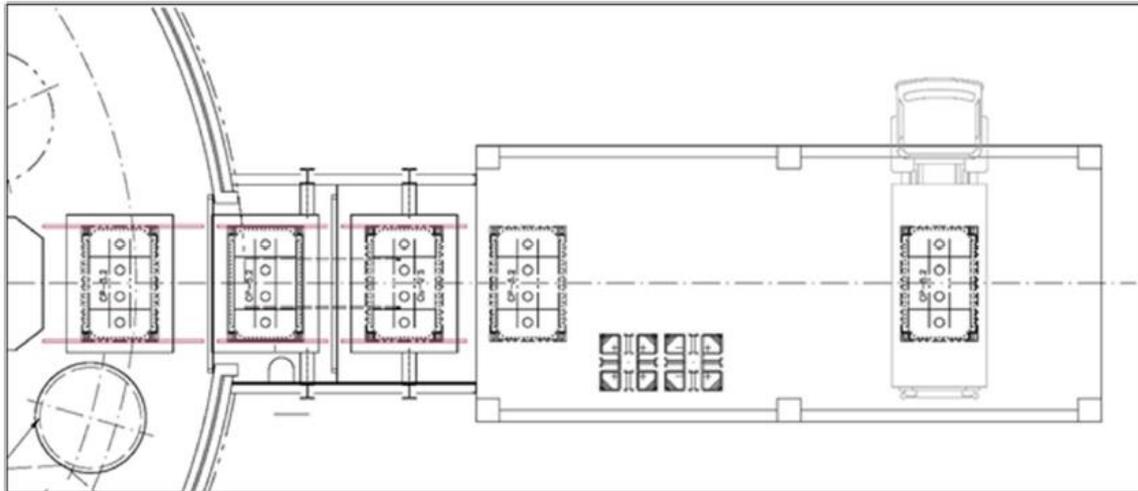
Layout sistemazione accesso lato Sud al Contenitore Stagno (pianta)
